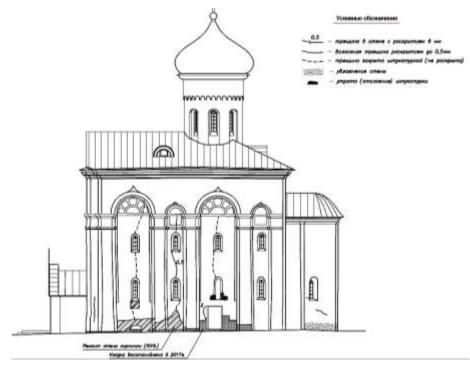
Южный фасад в 2018 г. до демонтажа поздних слоёв штукатурки
